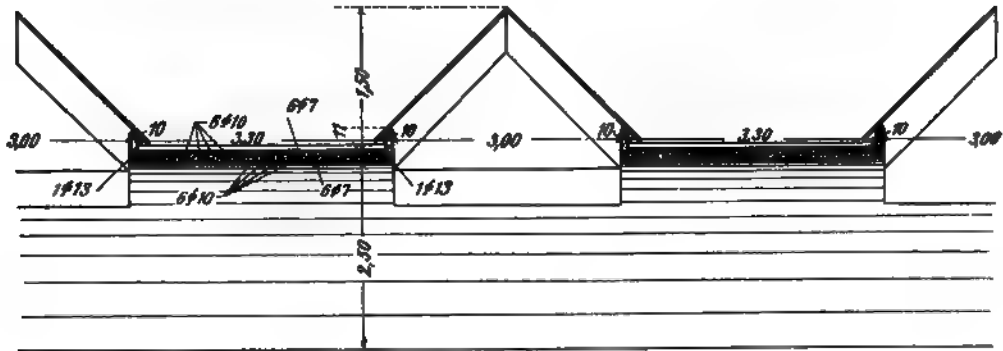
Längenschnitt durch den Gewölbescheitel mit Querschnitt der Oberlichter (zu Abb. 260)
